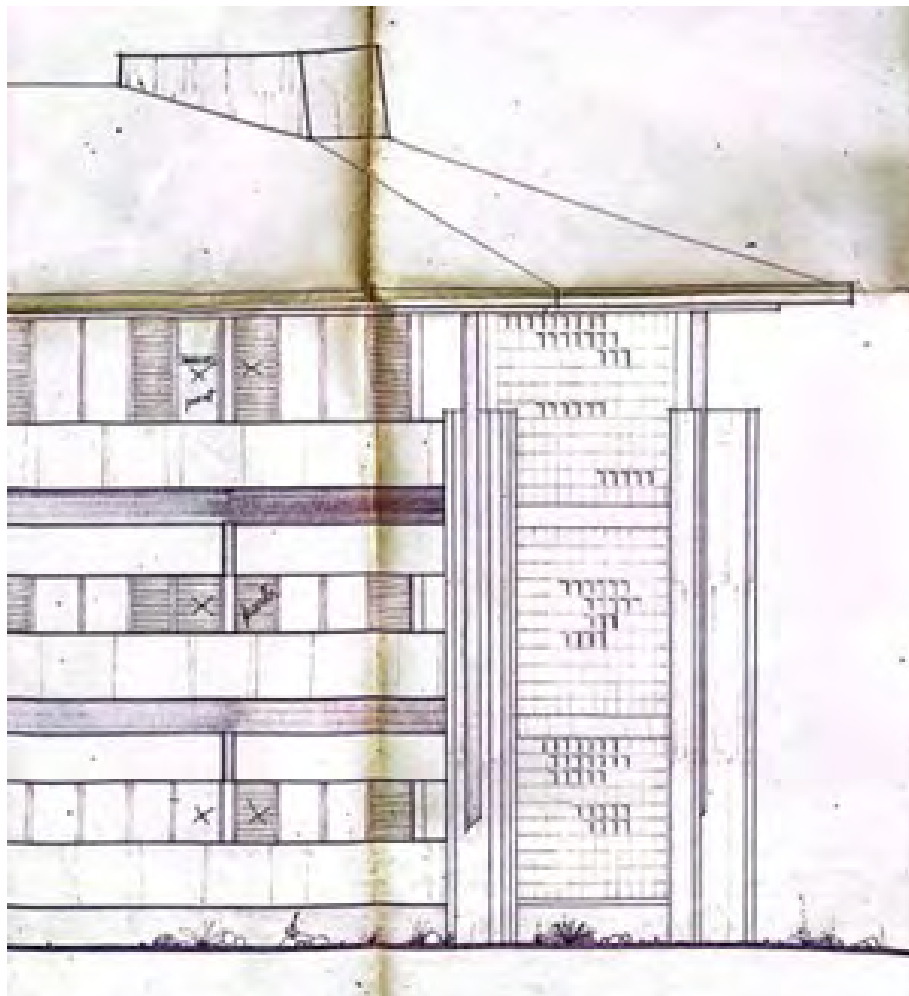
Detalhe da fachada em prancha para o projeto da Sede da SEDUC.
